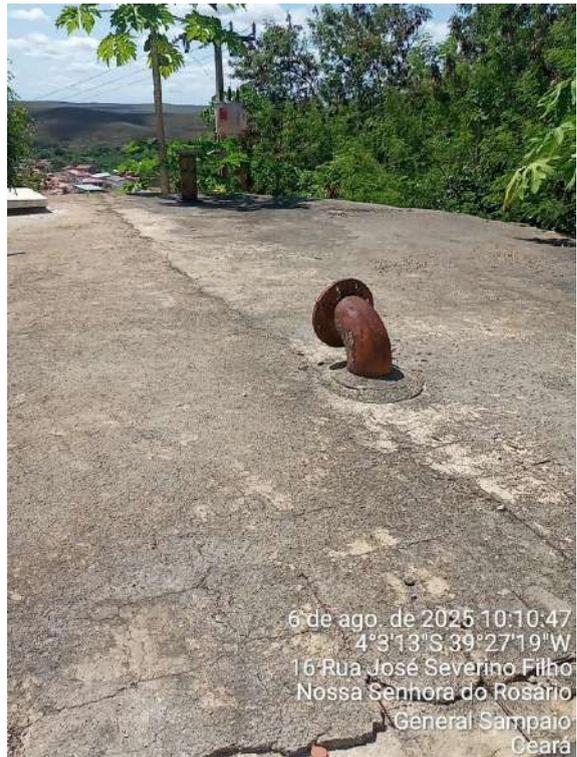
ETA: RAP sem grade de proteção / guarda corpo.
